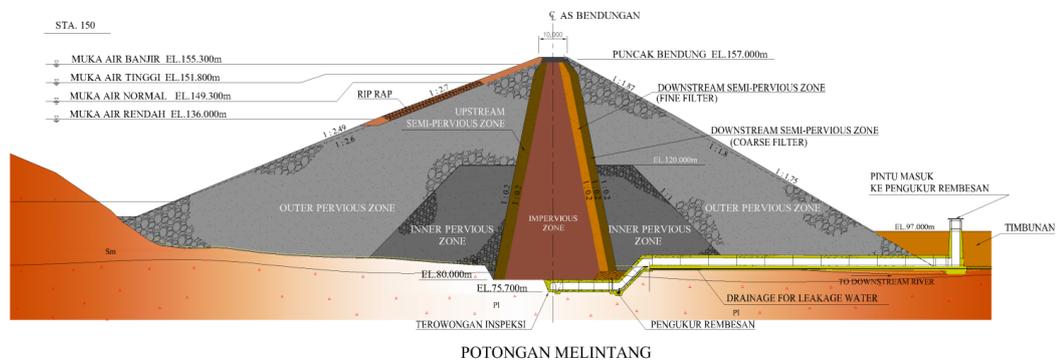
General Plan Pembangunan Bendungan Jatibarang (BBWS Pemali Juana)
